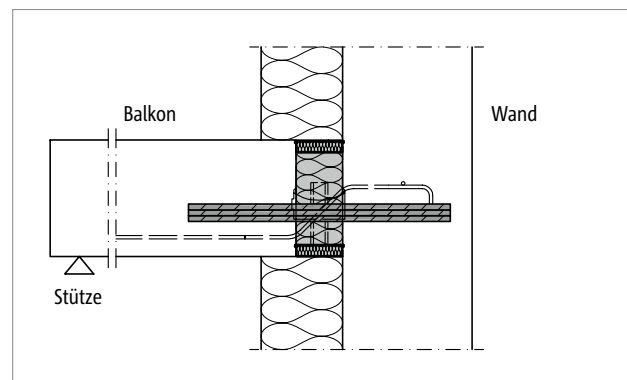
Schöck Isokorb® T Typ Q, H-VV-NN: Anschluss an einer Stahlbetonwand mit Außendämmung
